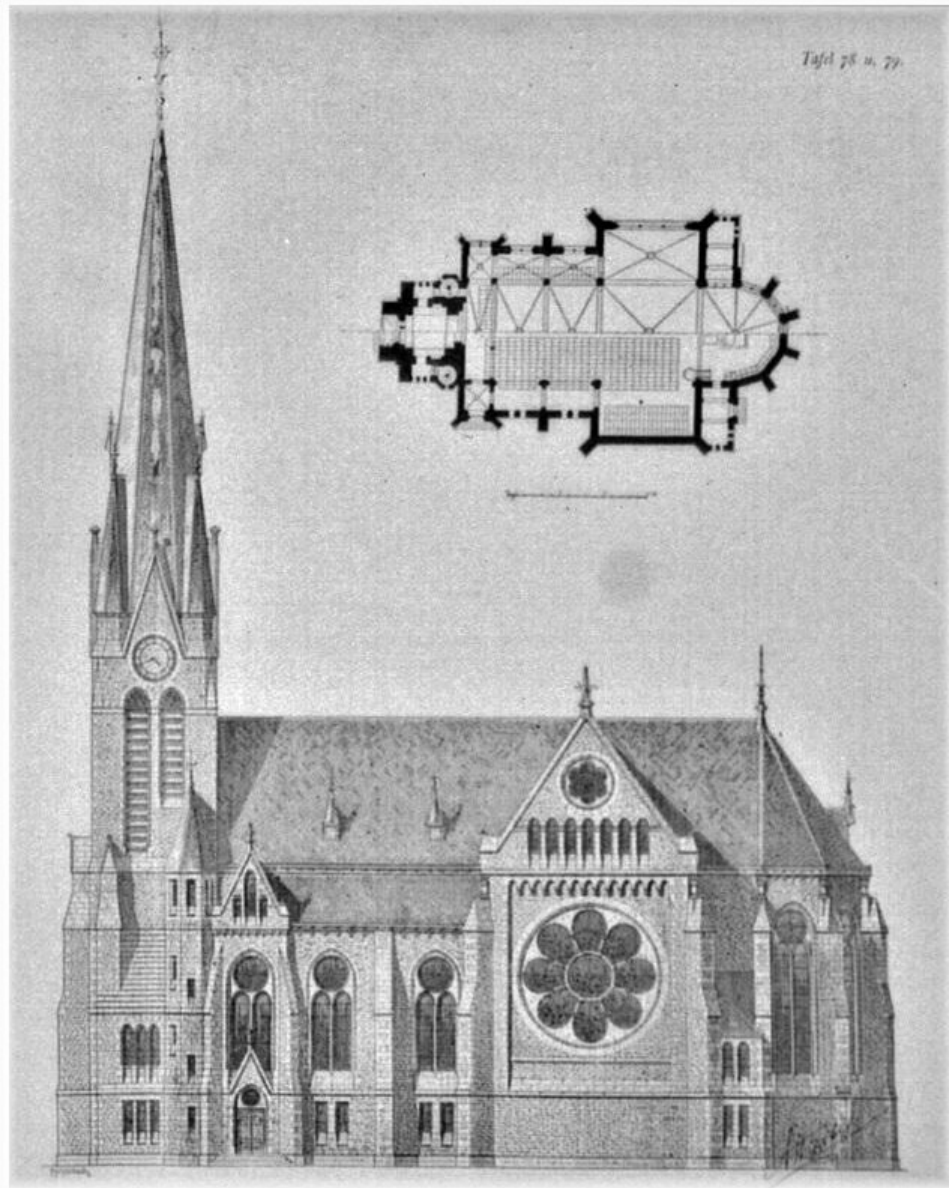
Seitenansicht und Grundriss Erdgeschoss/Emporengeschoss, Entwurf August Hartel
